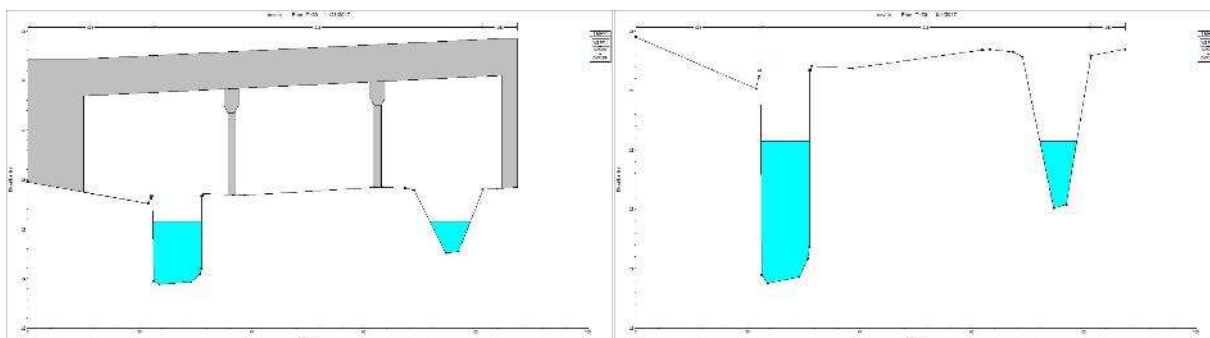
Sezione 6.5 valle (a sinistra) e sezione 6 (a destra), stato di fatto
